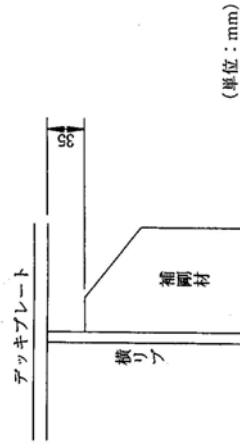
横リブまたは横げたの垂直補剛材の取付け構造の標準
